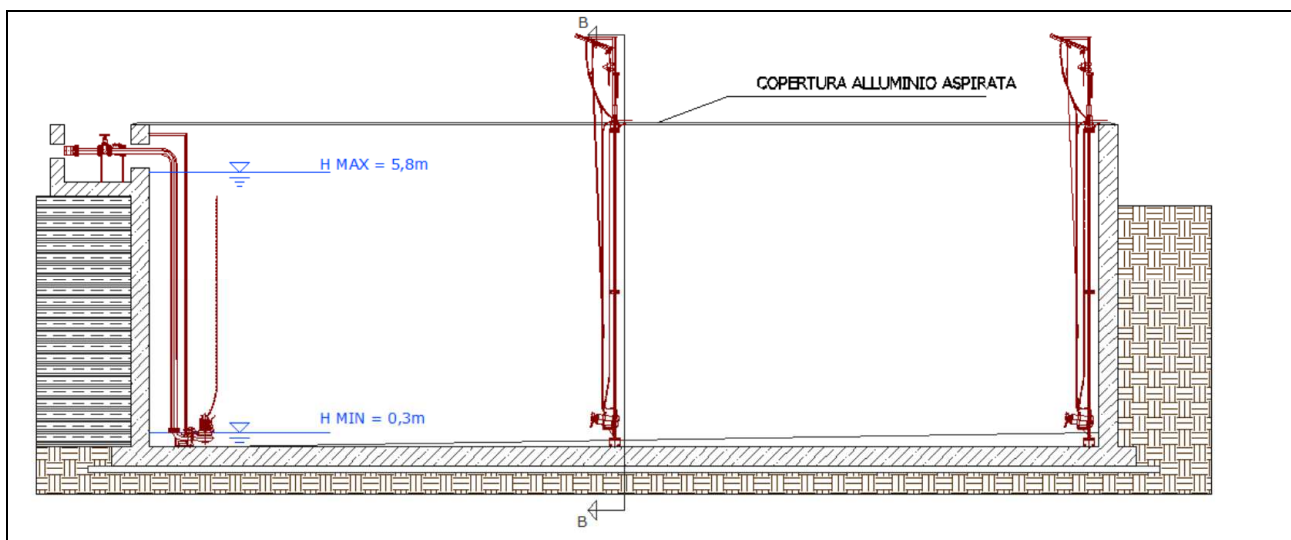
Sezione tipo Nuova vasca in calcestruzzo - Impianti
